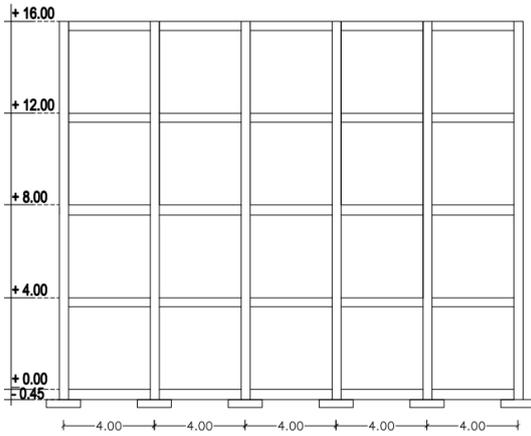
(Model A) Portal gedung tampak samping tanpa struktur *tie beam
